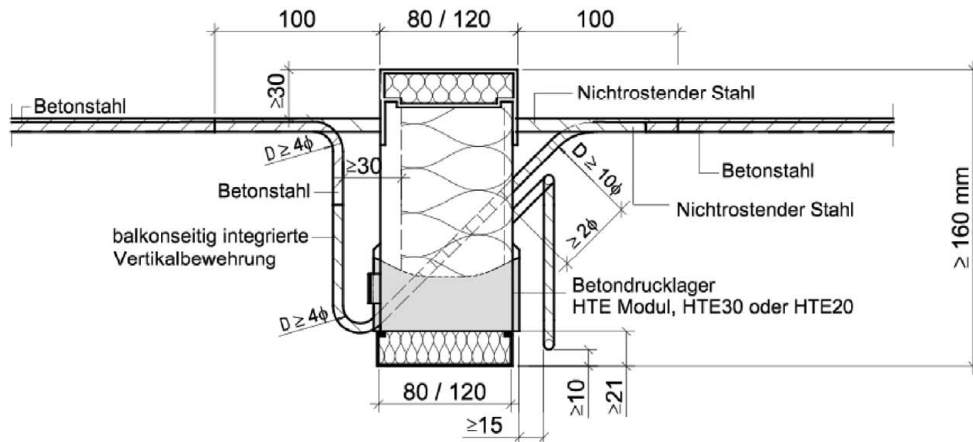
Schöck Isokorb® Typ K-ID¹⁾ mit Betondrucklager mit integrierter Aufhängebewehrung und Sonderbügel
